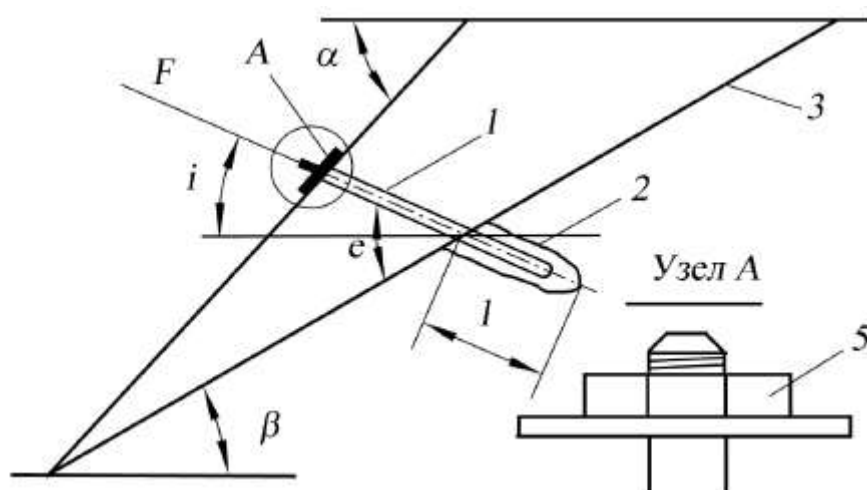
Схема укрепления уступа штангой: 1 – штанга; 2 – замок штанги длиной l ; 3 – поверхность ослабления; 4 – опорная металлическая накладка; 5 – гайка
